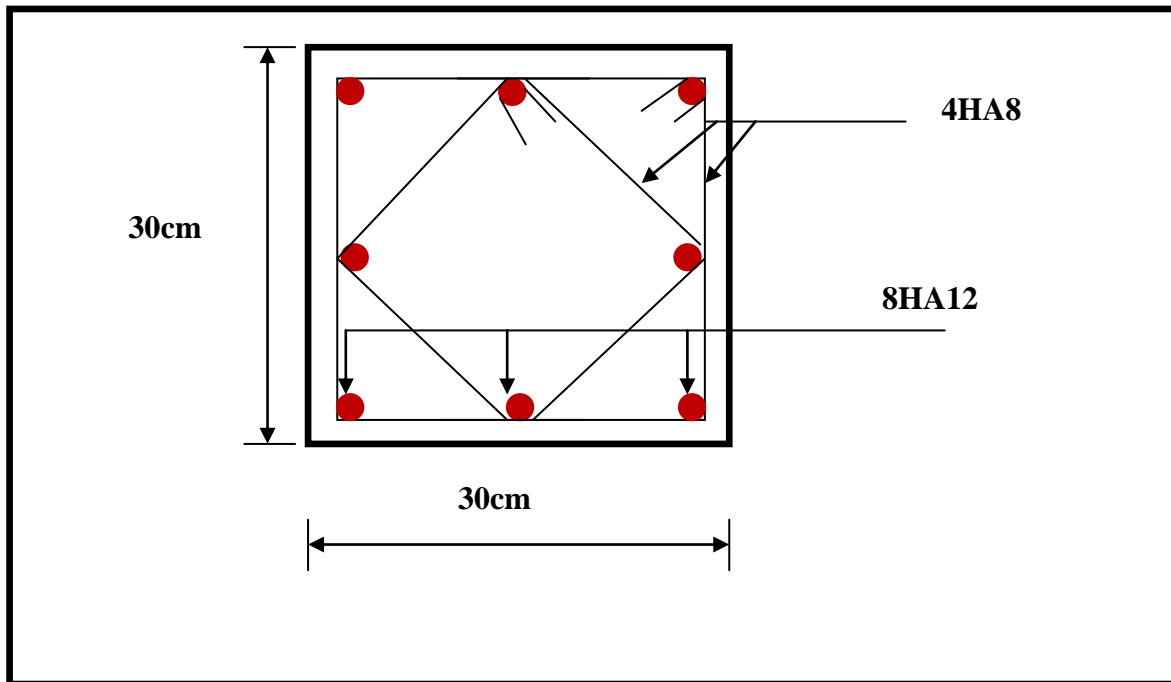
Ferrailage Poteau 30 × 30
